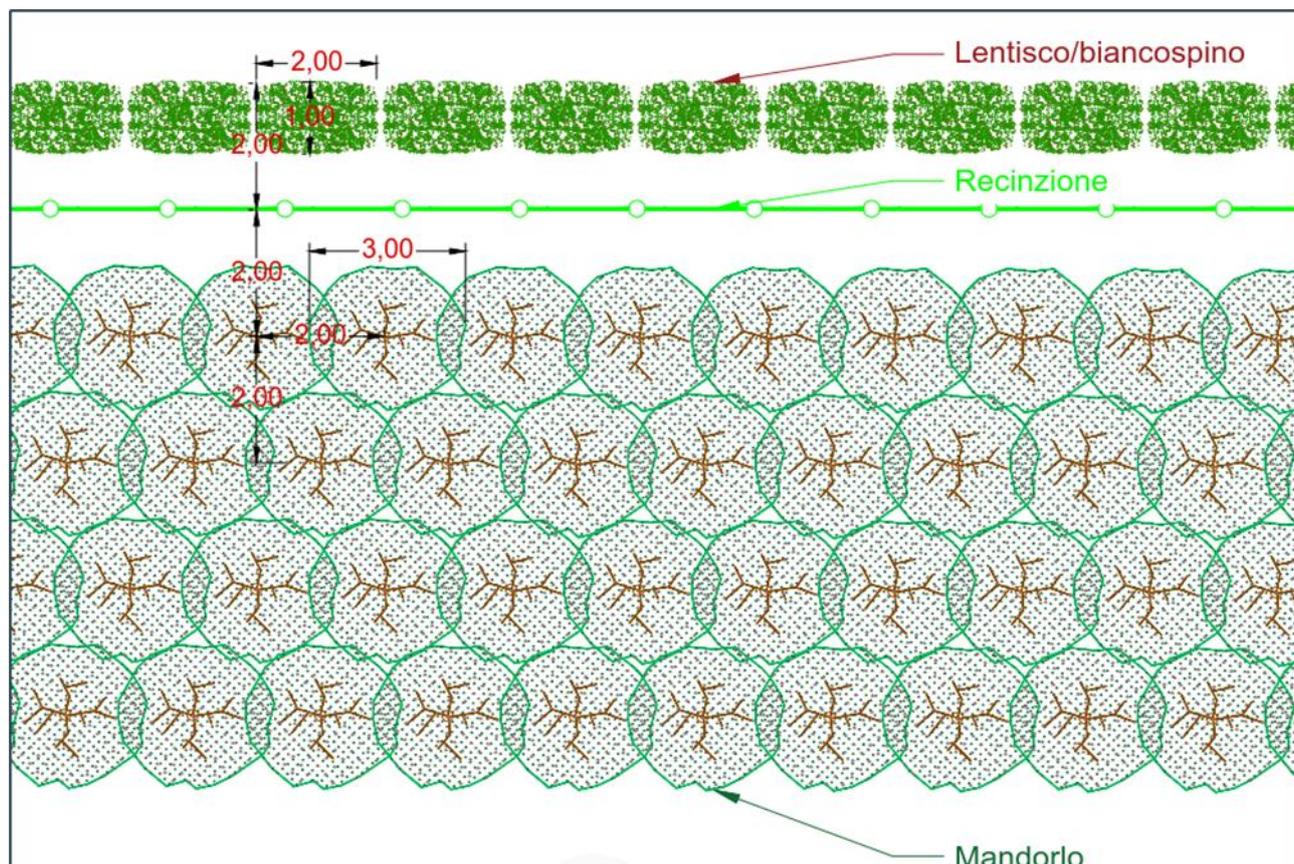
Sesto d'impianto della fascia perimetrale con larghezza 10 m
